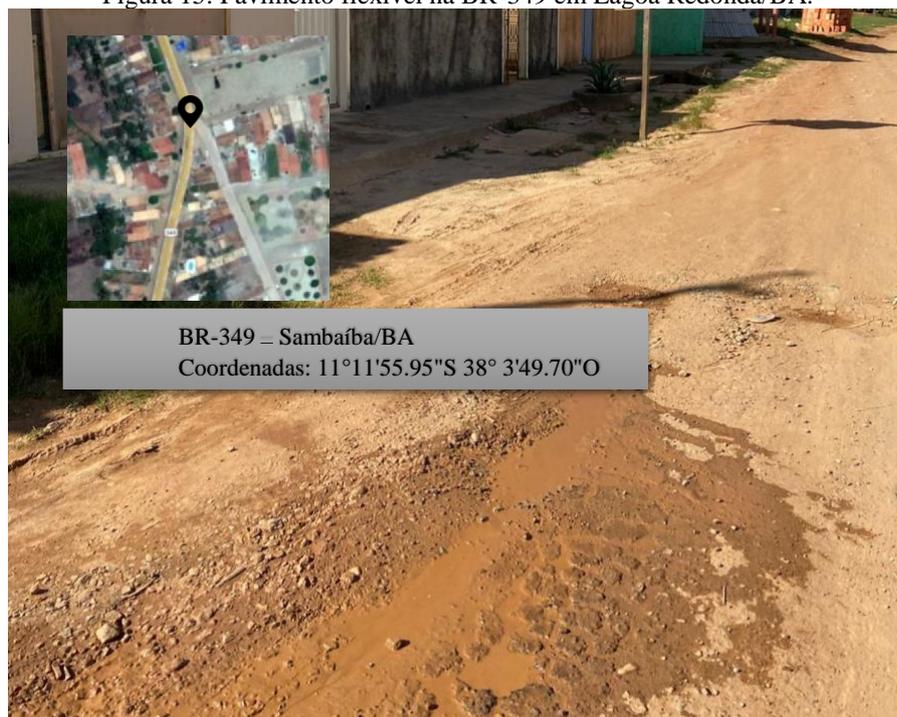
Pavimento flexível na BR-349 em Lagoa Redonda/BA.
